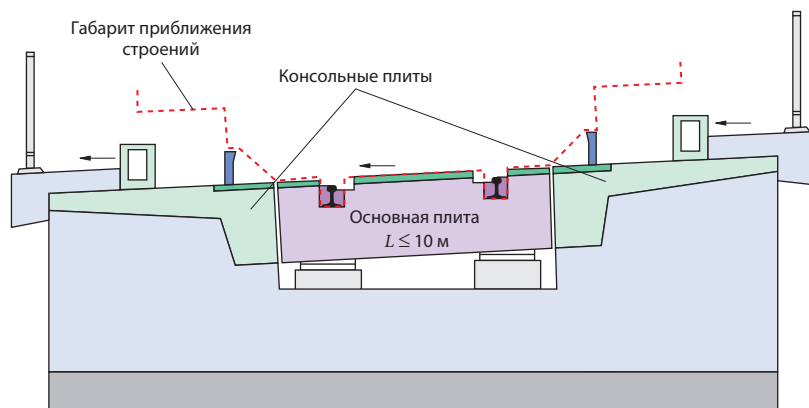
Конструкция мостового строения пути FiL-Rail SLEP-Bridge
